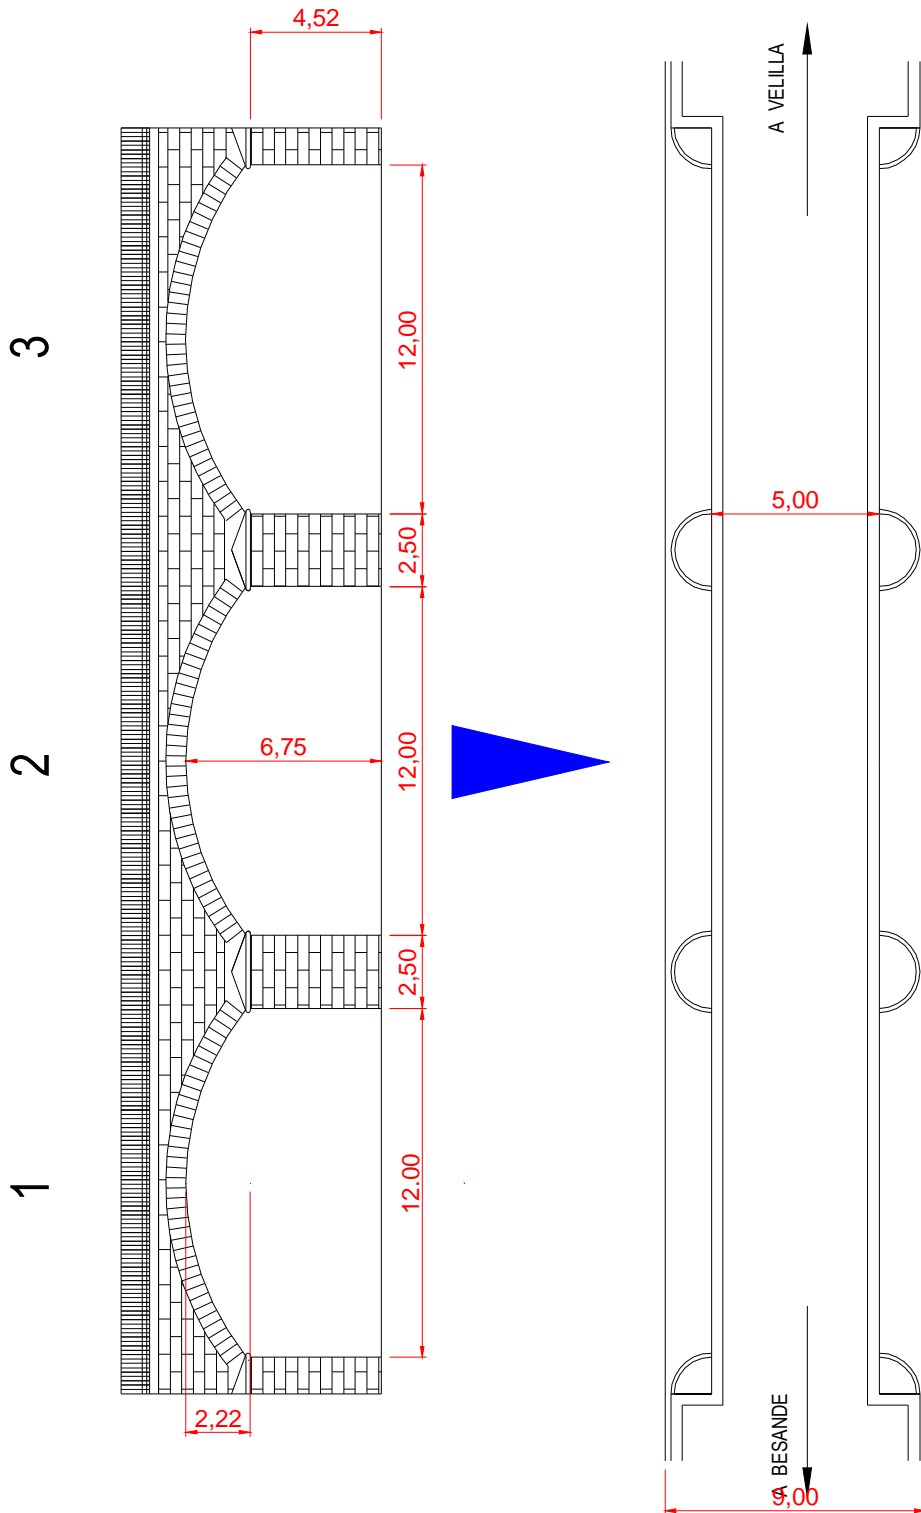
Planta y alzado de aguas arriba del puente en Velilla del río Carrión.
